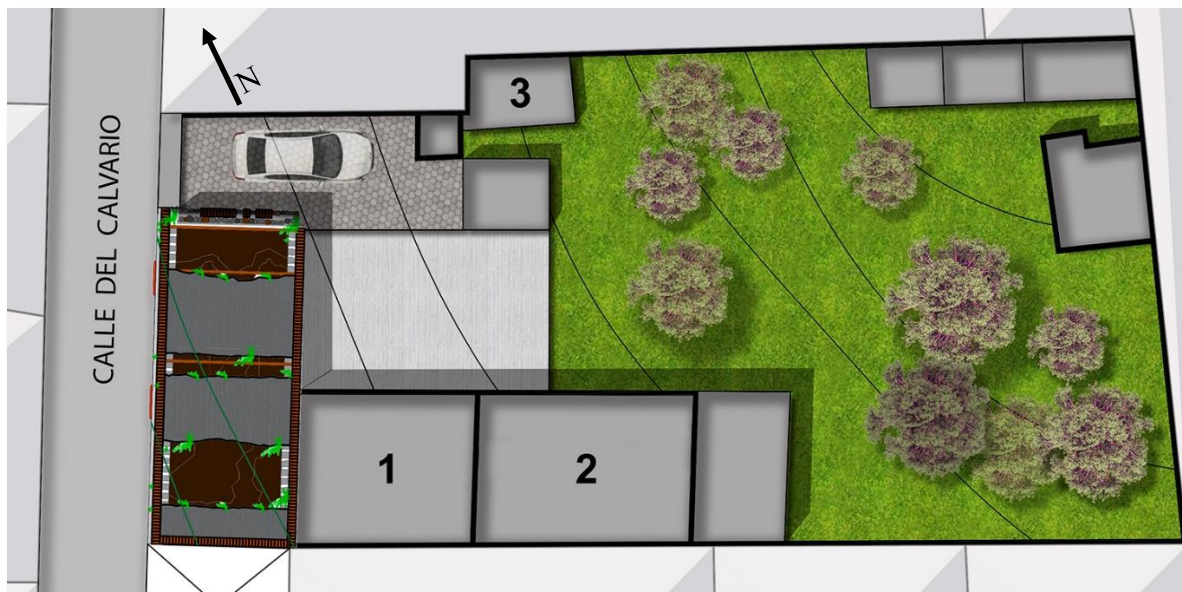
Planta esquemática situación actual, sin escala. Elaboración propia
